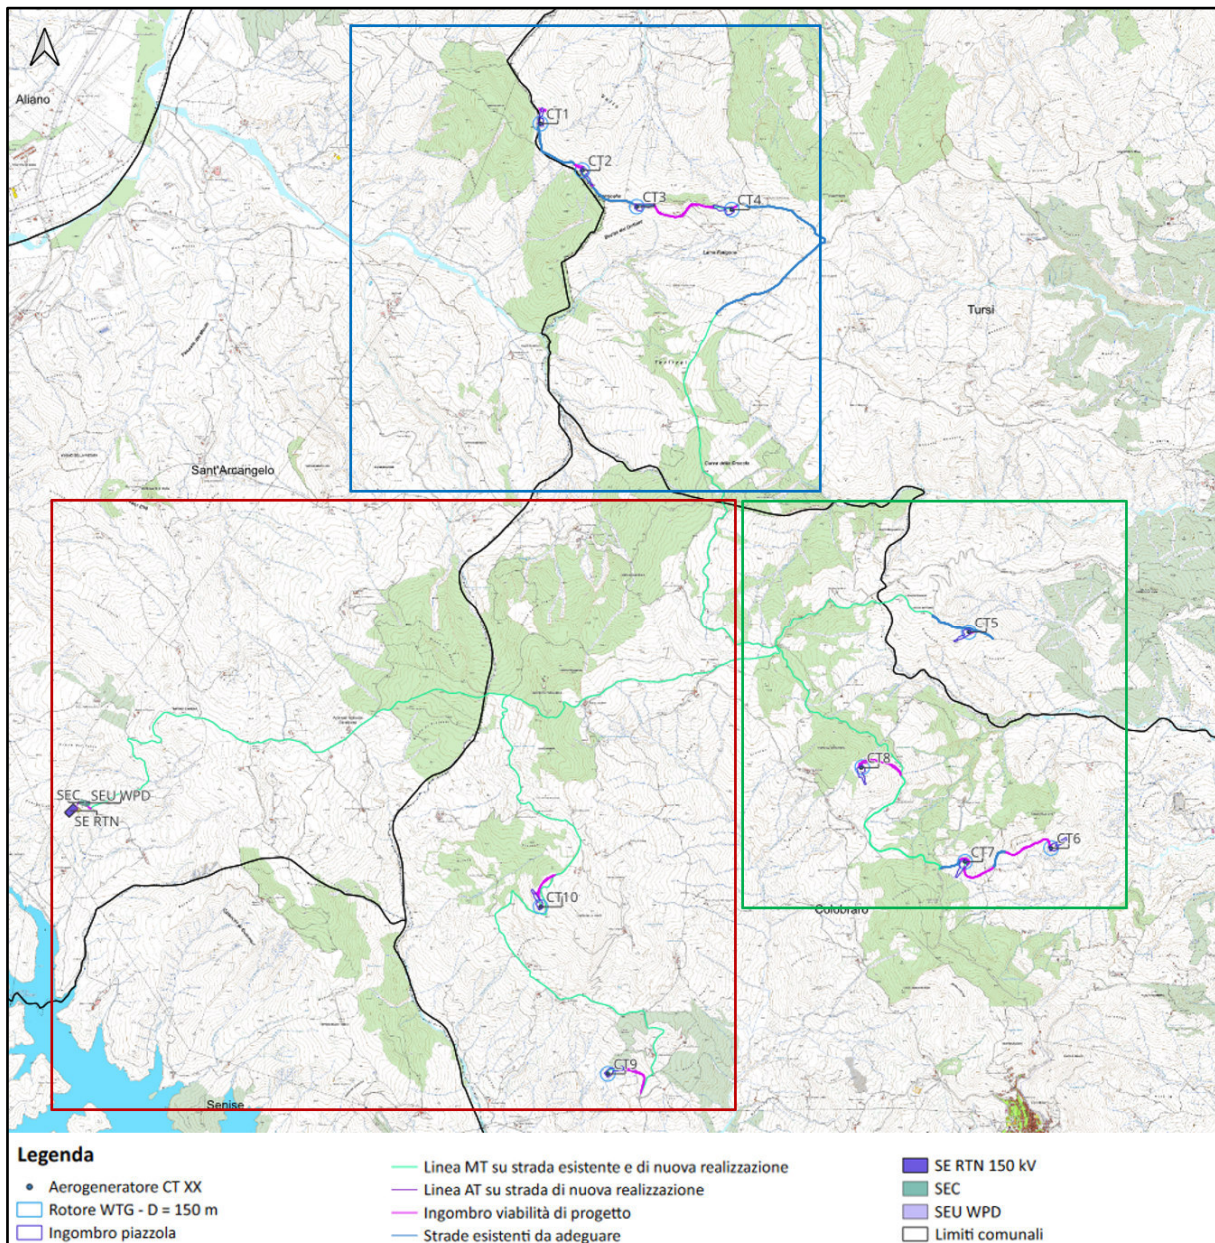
Layout d'impianto suddiviso in zone su CTR: Zona 1 - rettangolo rosso, Zona 2 - rettangolo azzurro, Zona 3 - rettangolo verde
